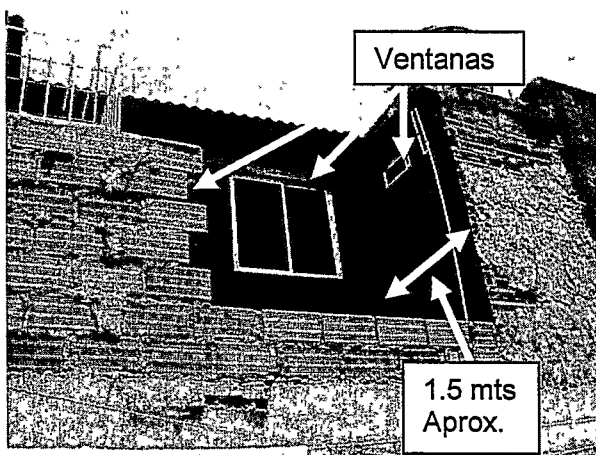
Detalle donde se observa la separación que tienen las ventanas del Inmueble vecino.
